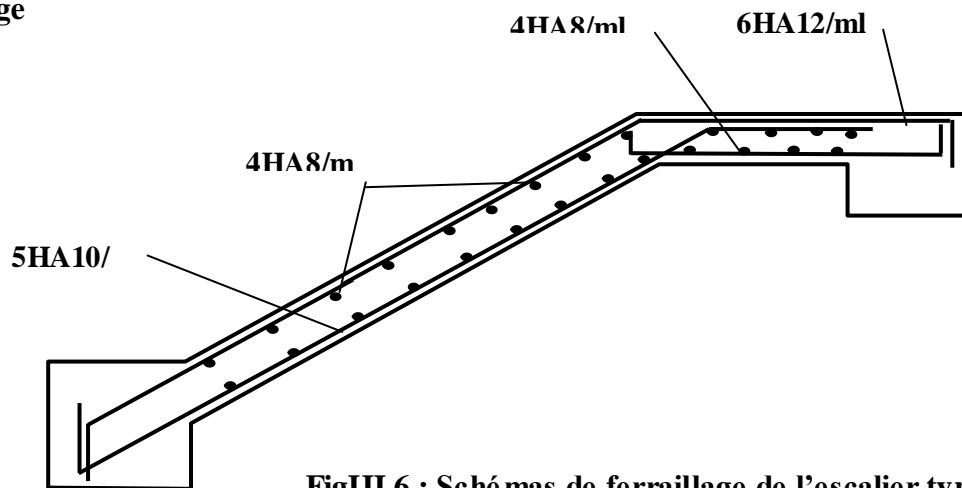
Schémas de ferrailage de l'escalier type 1
